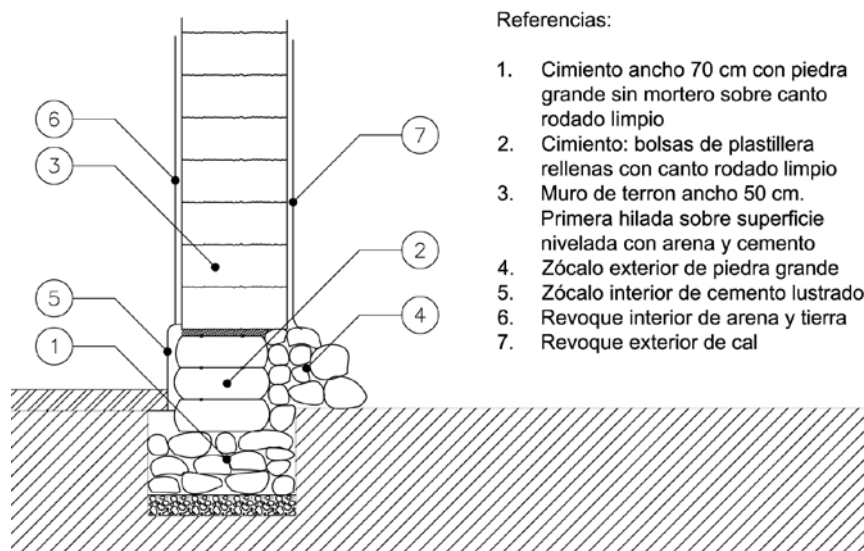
Detalle constructivo. Ilustración del proyecto *enTerrón*, 2013.
